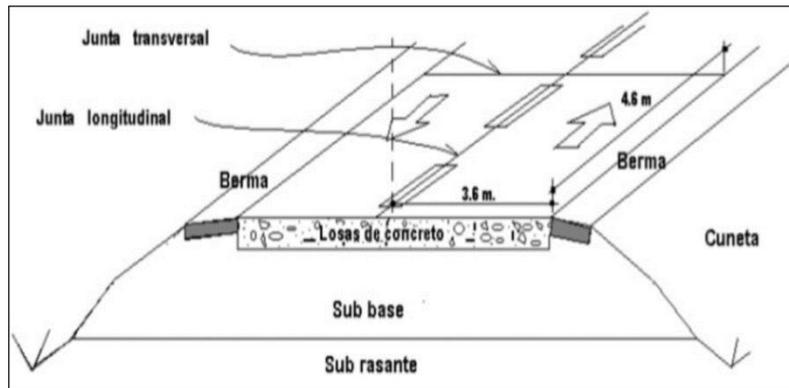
Estructura de un pavimento rígido. Nota. Monsalve et al. (2012).
